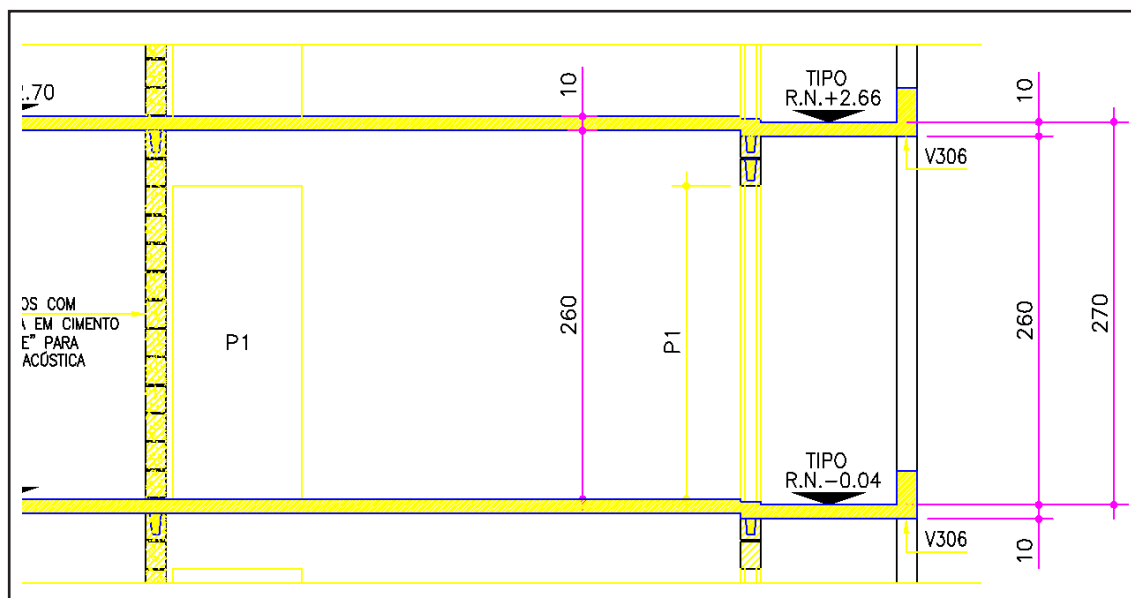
Corte de projeto 2D - viga invertida para sacada
